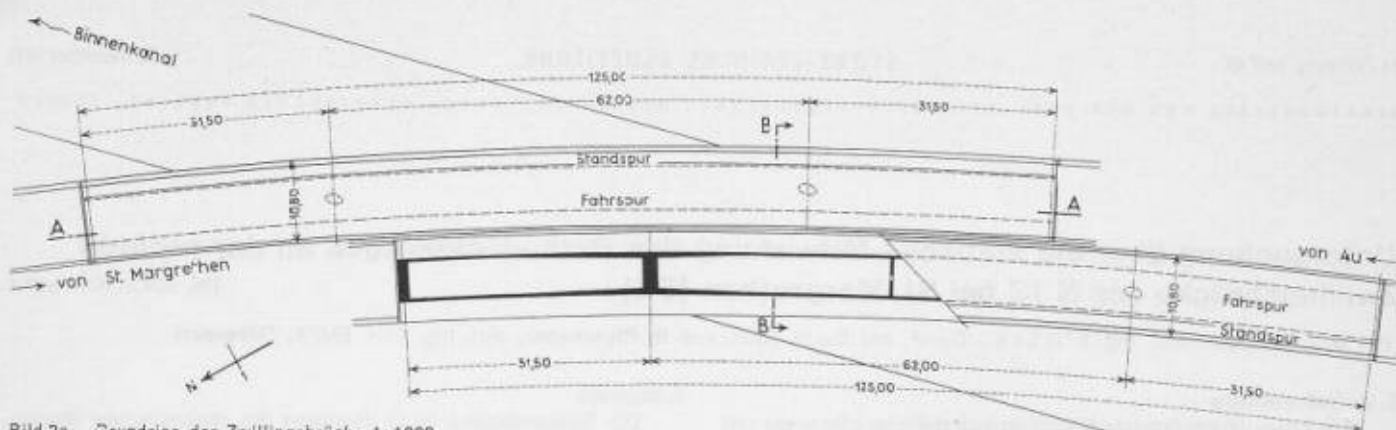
Grundriss der Zwillingsbrücke 1:1000
